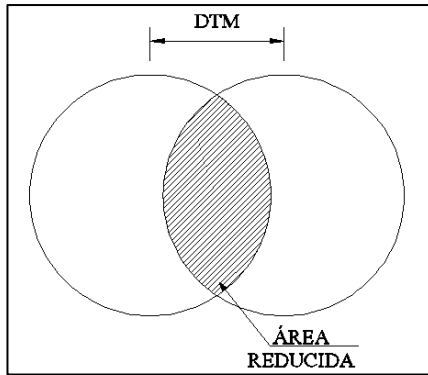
Vista en planta de la reducción del área del aislador debido a DTM.
